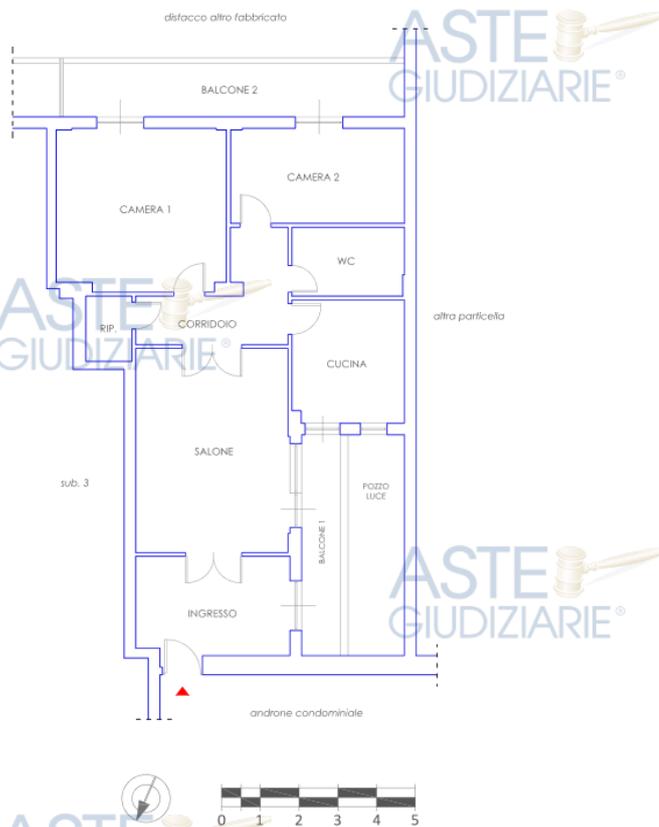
Planimetria di rilievo dello stato di fatto (All. 6).
